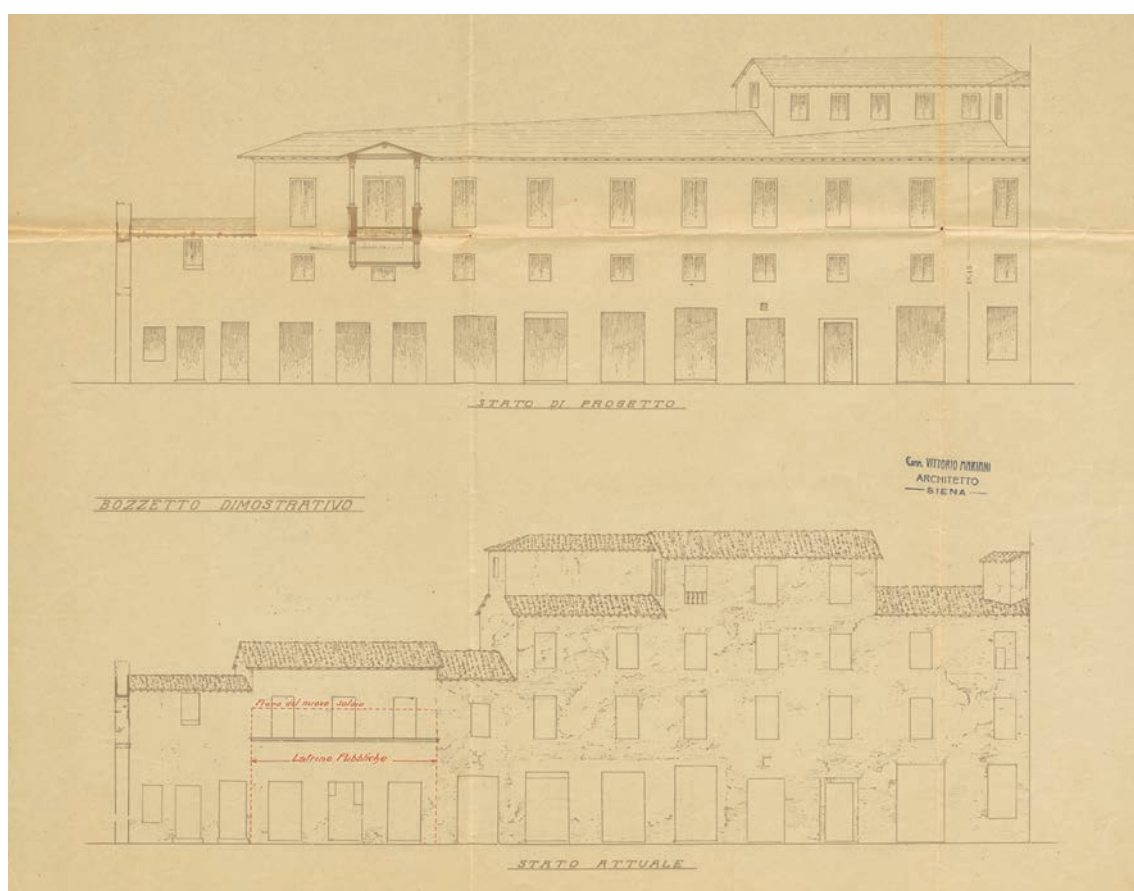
Prospetti e sezione dei fronti su via Beccheria a firma di Vittorio Mariani, ASCSi.
